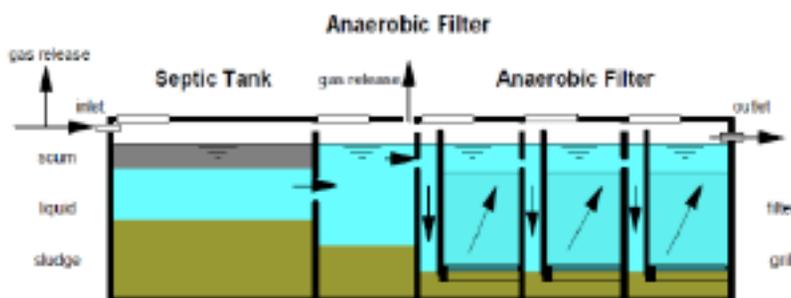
Contoh skema bangunan pengolahan air limbah sederhana sistem on-site
